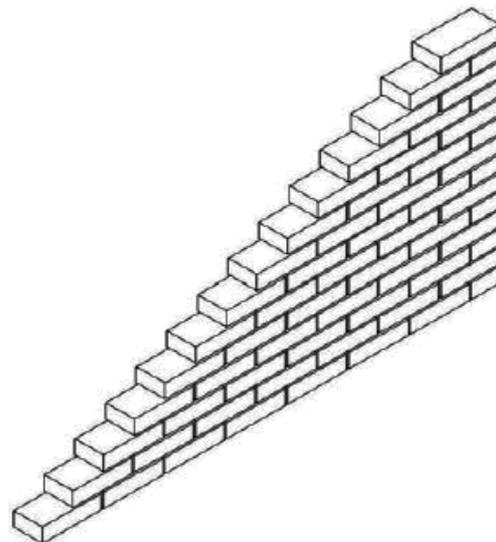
Muro cara vista de ladrillo tradicional de hormigón.
